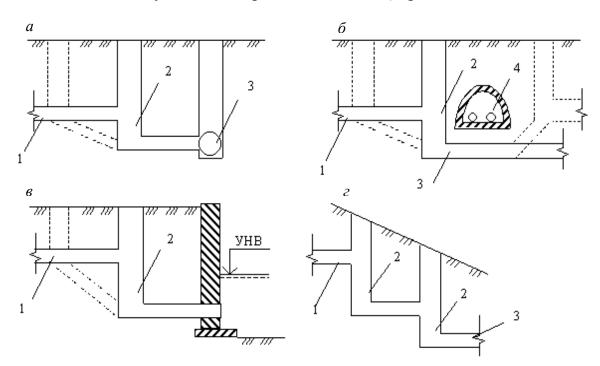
Случаи установки перепадных колодцев 1 – подводящий трубопровод; 2 – перепадный колодец; 3 – отводящий трубопровод; 4 – препятствие
